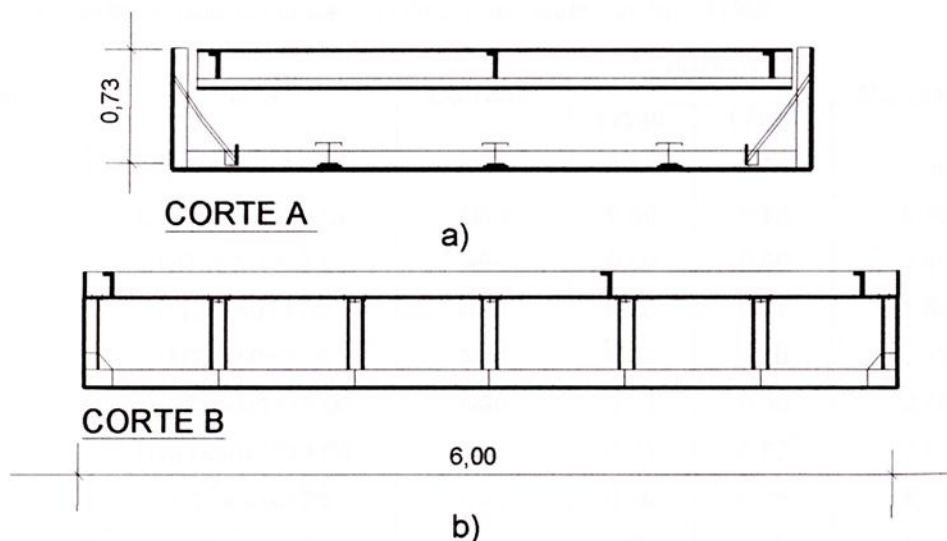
Caixa de sucção – dimensões gerais: (a) Corte transversal. (b) Corte longitudinal, segundo Javaroni (1999)
